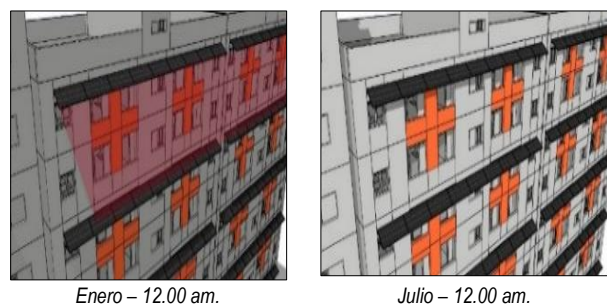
Sombras de la instalación SFV sobre la fachada del edificio en estudio.
